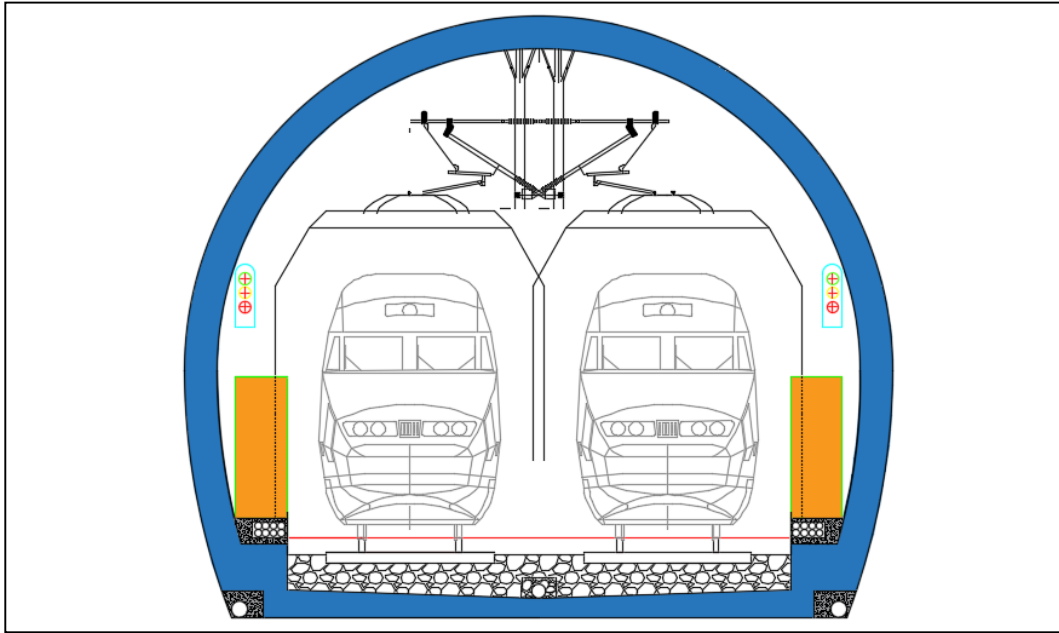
Section transversal du tunnel avec matériel roulant dans le cas d'un bon sol
